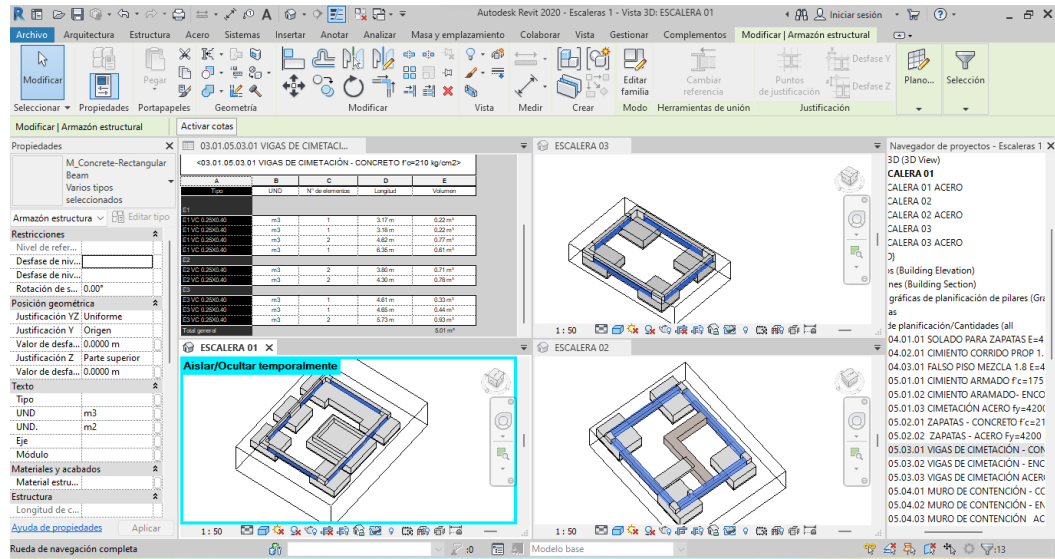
Modelado y metrados de la partida Vigas de cimentación Modulo Escaleras.
